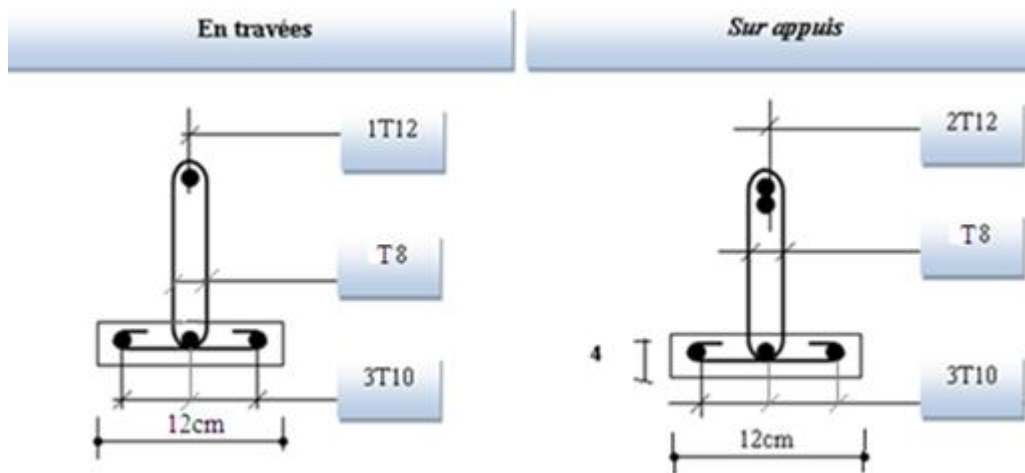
Ferrailage de la poutrelle en travée et sur appuis.
